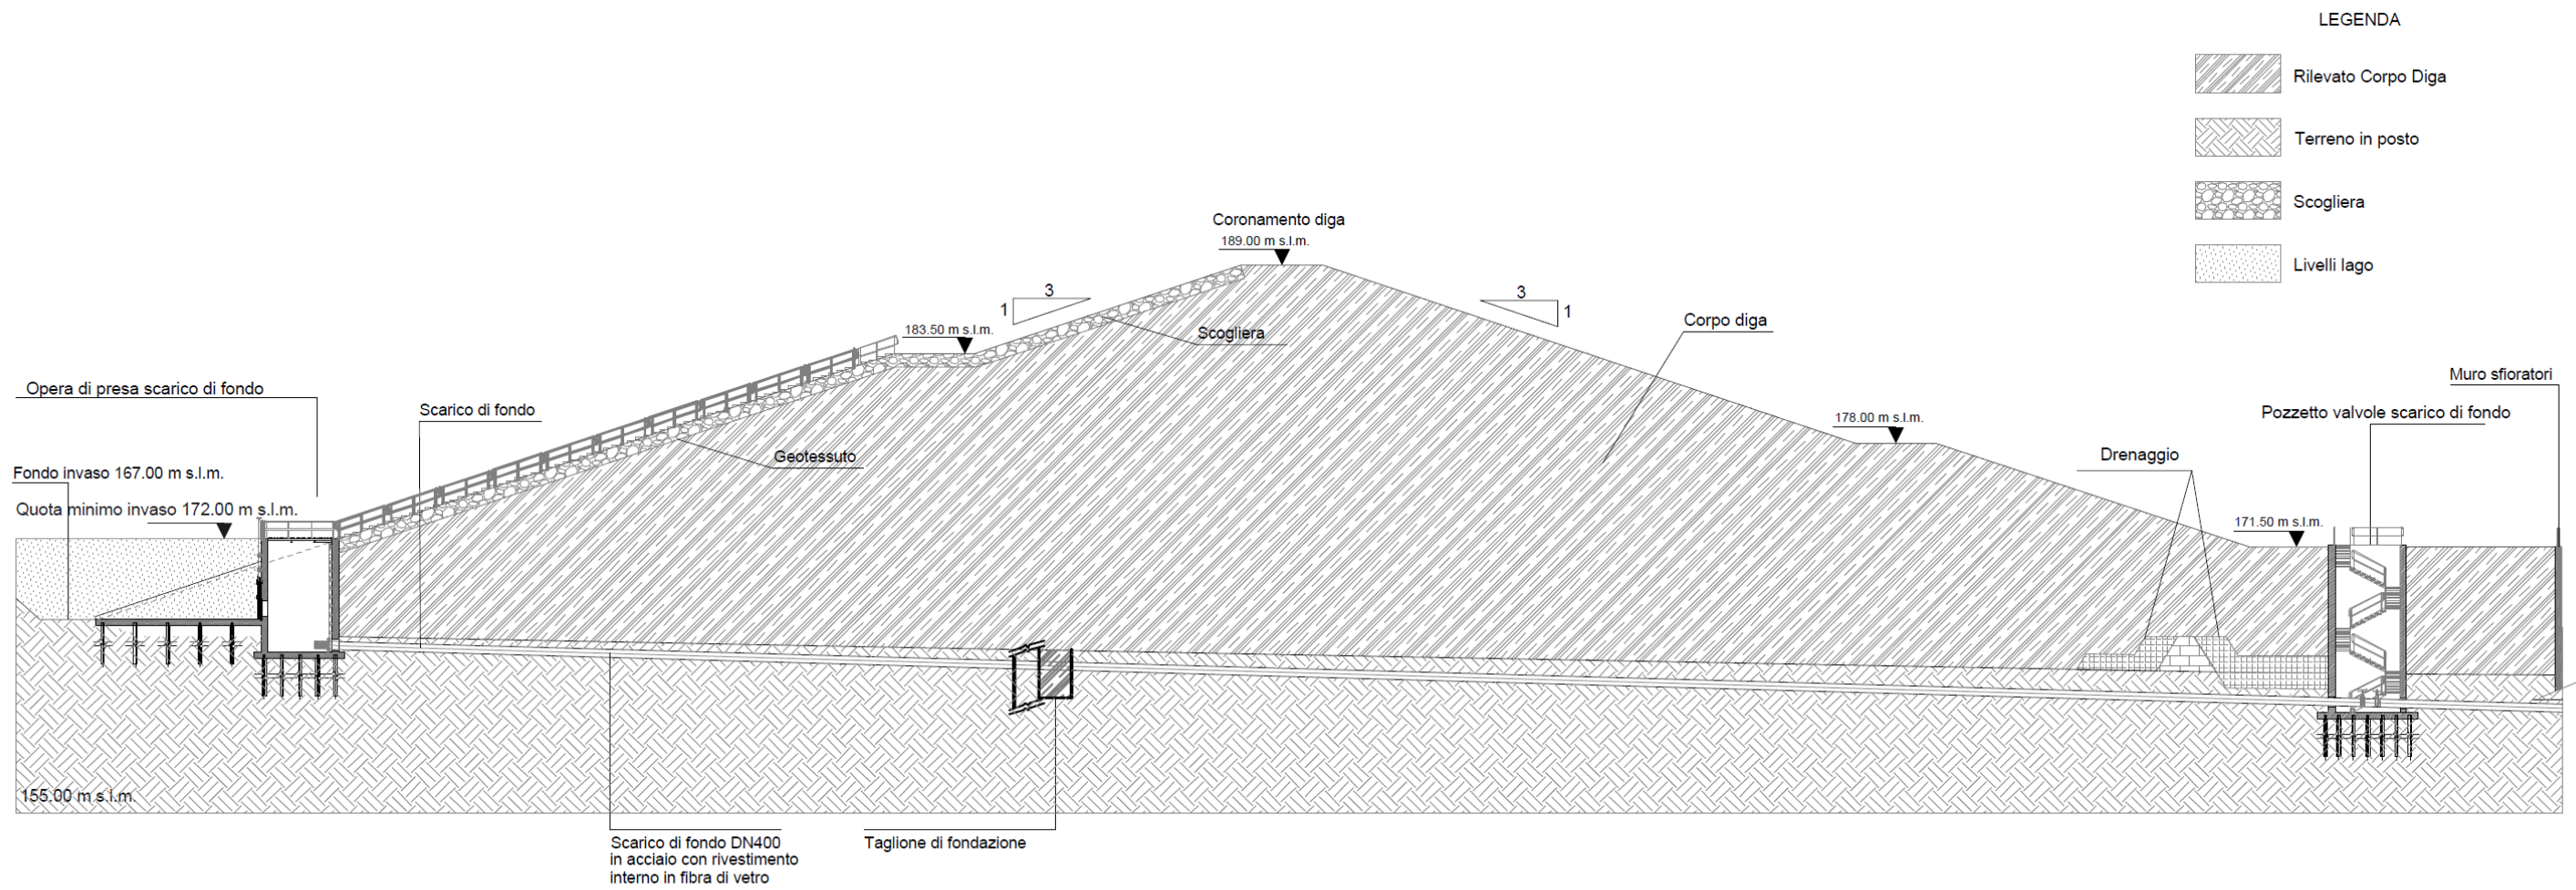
Sezione trasversale della diga Drove di Cepparello nello stato di progetto.
